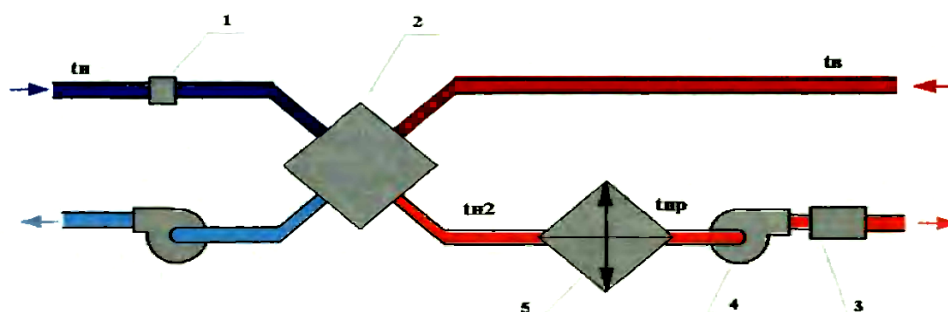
Схема местной системы вентиляции с теплоутилизатором
